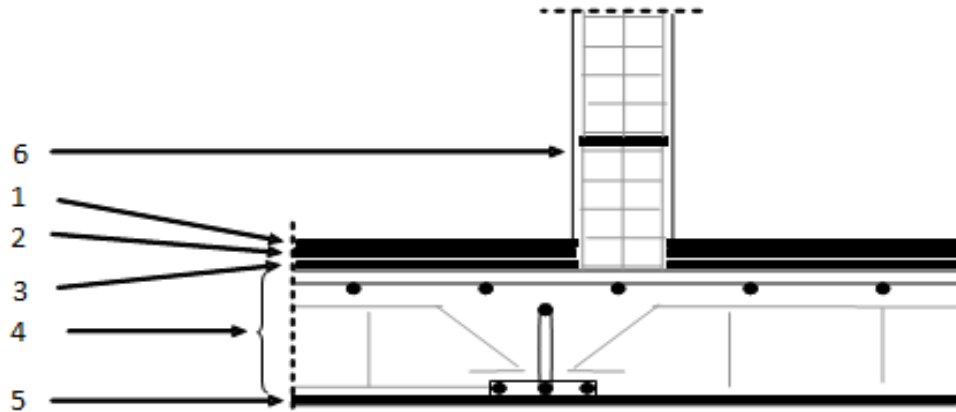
Coupe verticale de la dalle pleine (étage courant).
